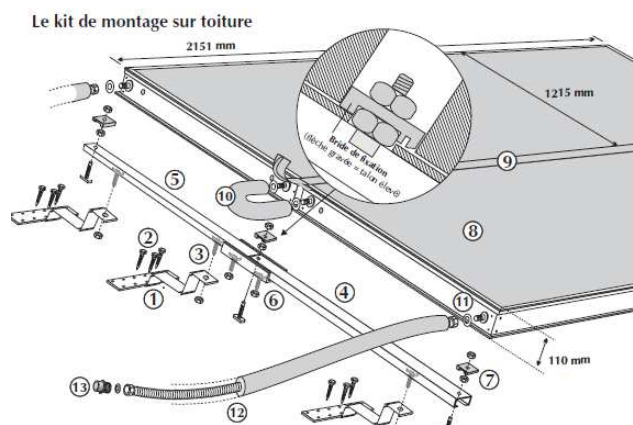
Kit de base de montage sur toiture du capteur EURO disposé horizontalement ou verticalement (ici : exemple de disposition horizontale): 1 plaque d'ancrage sur chevrons, 2 vis taraudeuses Øx80, 3 vis papillon en inox M10x30 avec écrou, 4 rail de montage de base en aluminium, long. 1257 mm, 5 rail d'extension 1223 mm de long, 6 plaque d'accouplement avec vis papillon en inox M10x30 avec écrou, 7 bride de fixation EURO avec vis papillon en inox M10x30 et 2 écrous, 8 capteur EURO (ne fait pas partie du kit de base), 9 profilé d'éclanché T en silicone, 10 flexible inox avec écrou à raccord 1/2" et isolation 20x13 mm, long. 235 mm, 11 joint d'éclanché, 12 flexible inox avec écrou à raccord 1/2" et isolation 20x13 mm, long. 900 mm, 13 raccord de soudage 1/2" 18 mm
